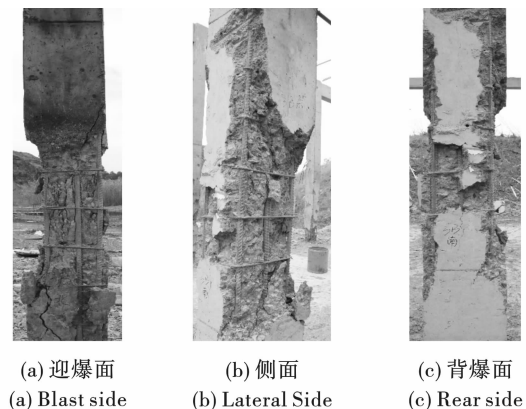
圆柱形装药爆炸钢筋混凝土柱的毁伤程度
